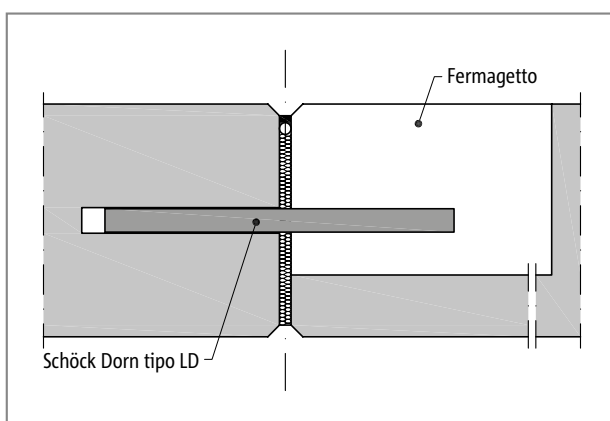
Schöck Dorn: giunti di dilatazione balcone prefabbricato
